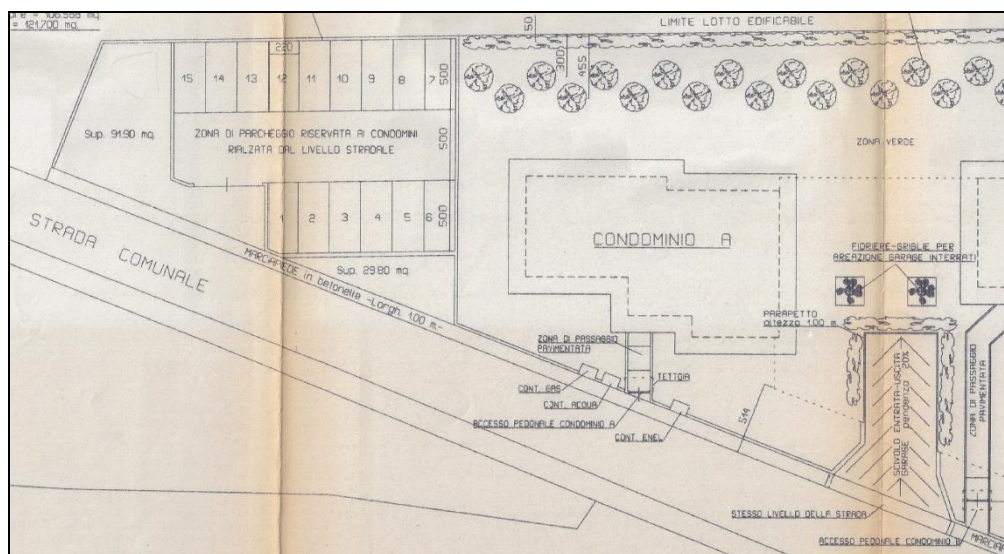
Planimetria sistemazione esterna lotto -Autorizzazione Edilizia Pratica n. A99/0083 del 15/10/2001 – ([Allegato N.7](#))
